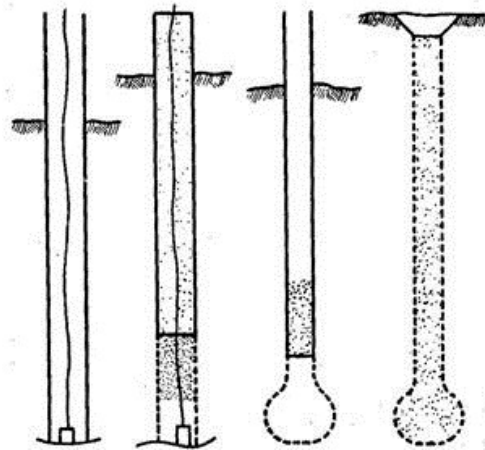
Forma de anclaje de los pilotes de hormigón "Wilhem". [E-46]
